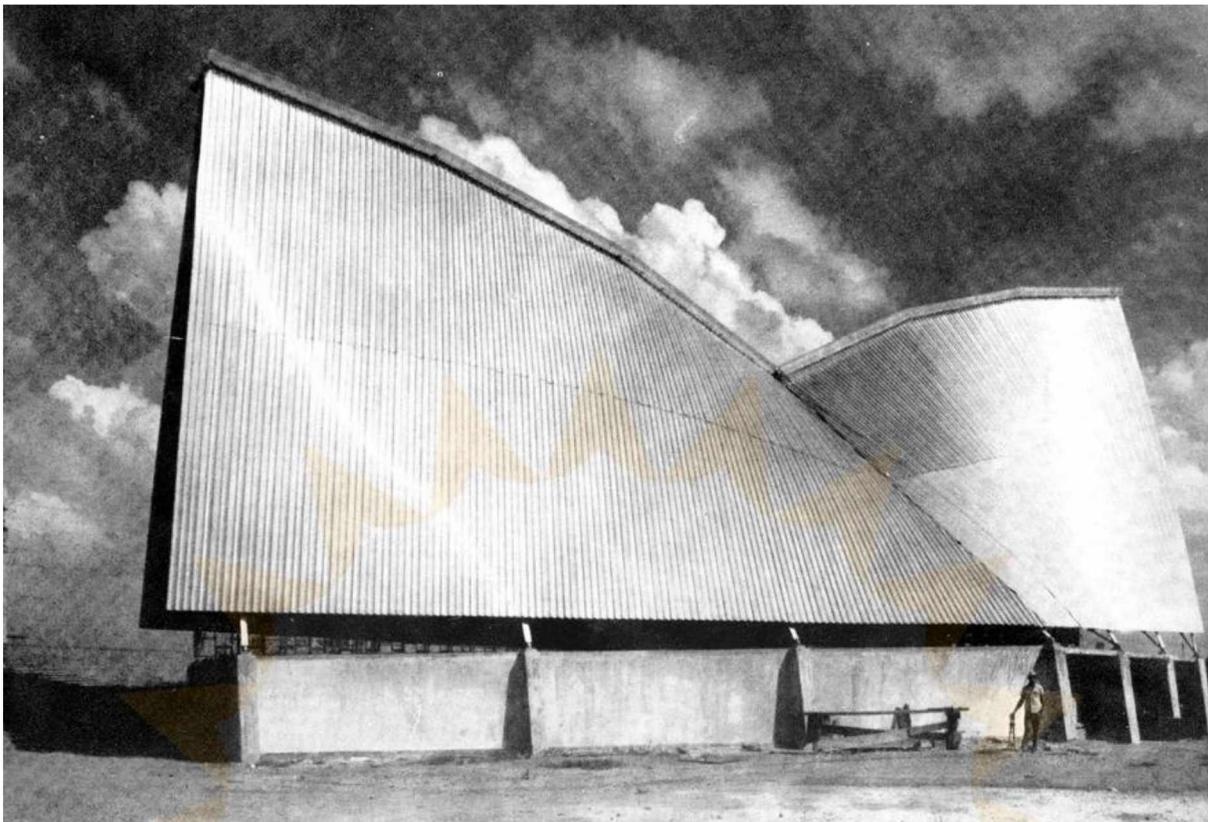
Fotografia da obra em construção e um desenho sobre a fachada. Arq. Jorge Caron.
